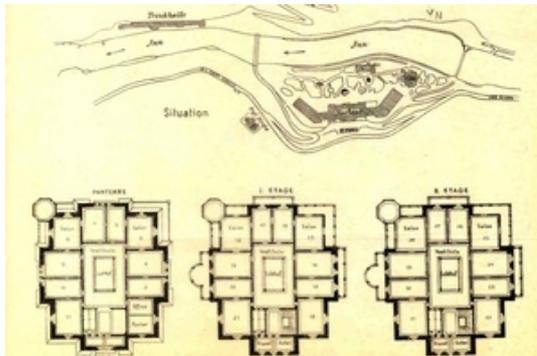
Tarasp, Situationsplan und Grundrisse Villa Kurhaus
